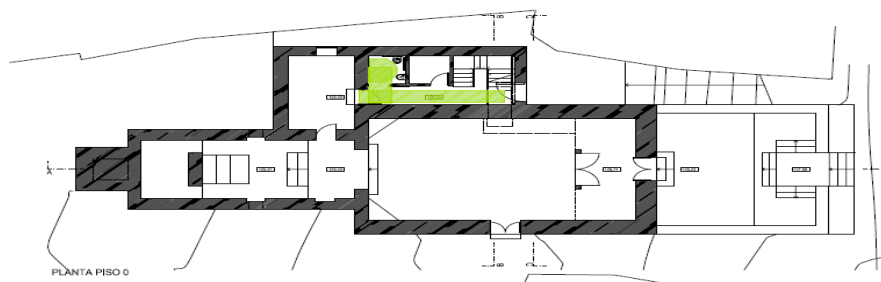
Planta da capela, intervenção nas acessibilidades. [9]
